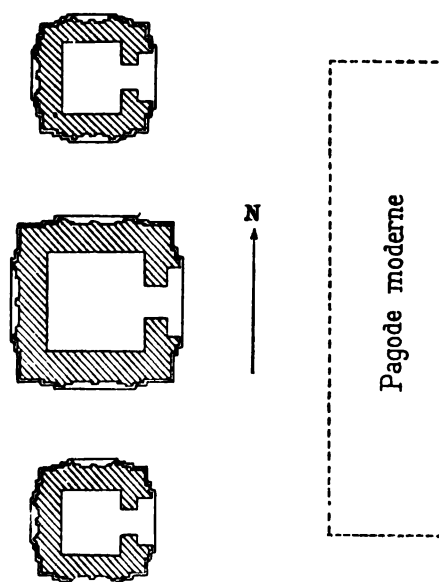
Phnom Trop, n° 101, groupe D. Plan.
